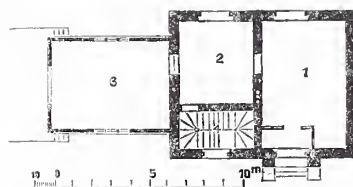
Grundriss vom Erdgeschoss.
